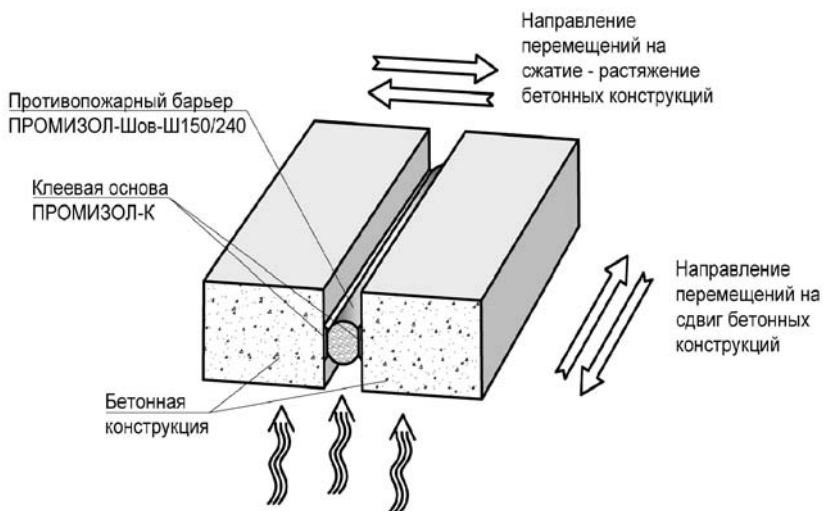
Модель испытательного стенда для проведения испытаний огнестойкой заделки
